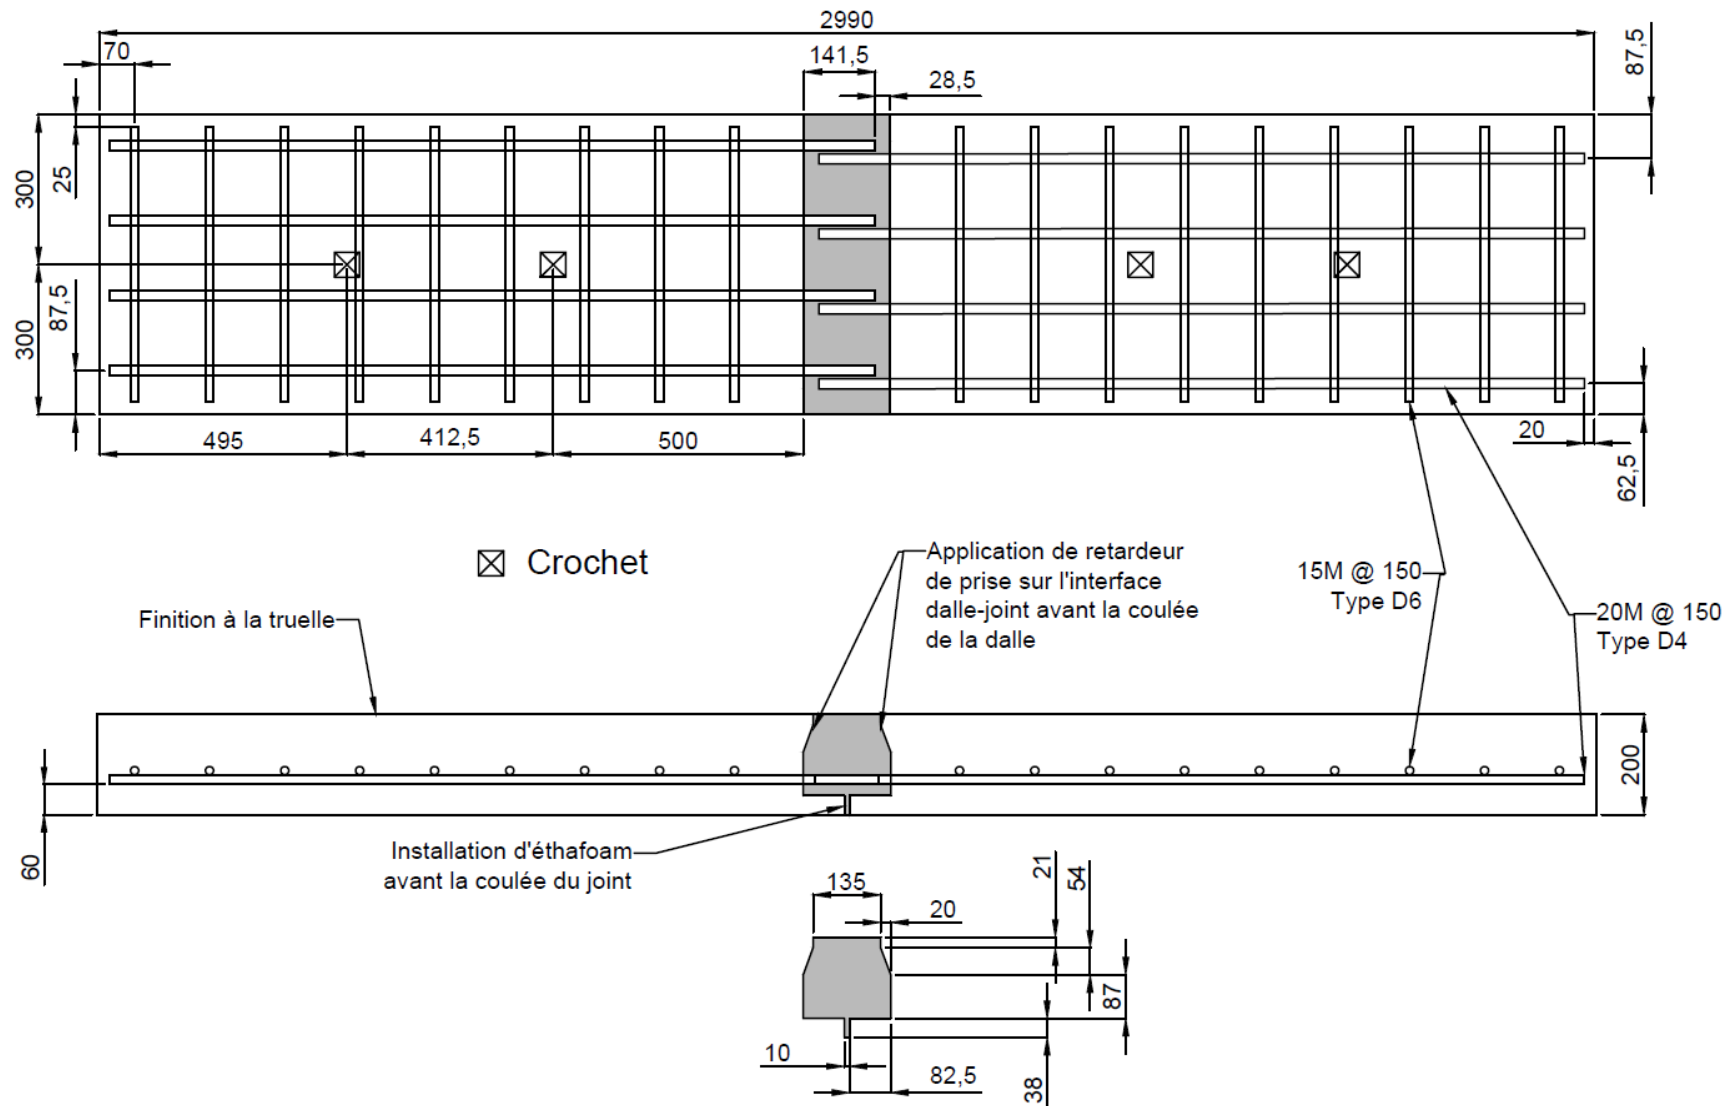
Dalle en BFHP avec joint de connexion longitudinale de 175 mm (TQC) pour le test statique (#5)
